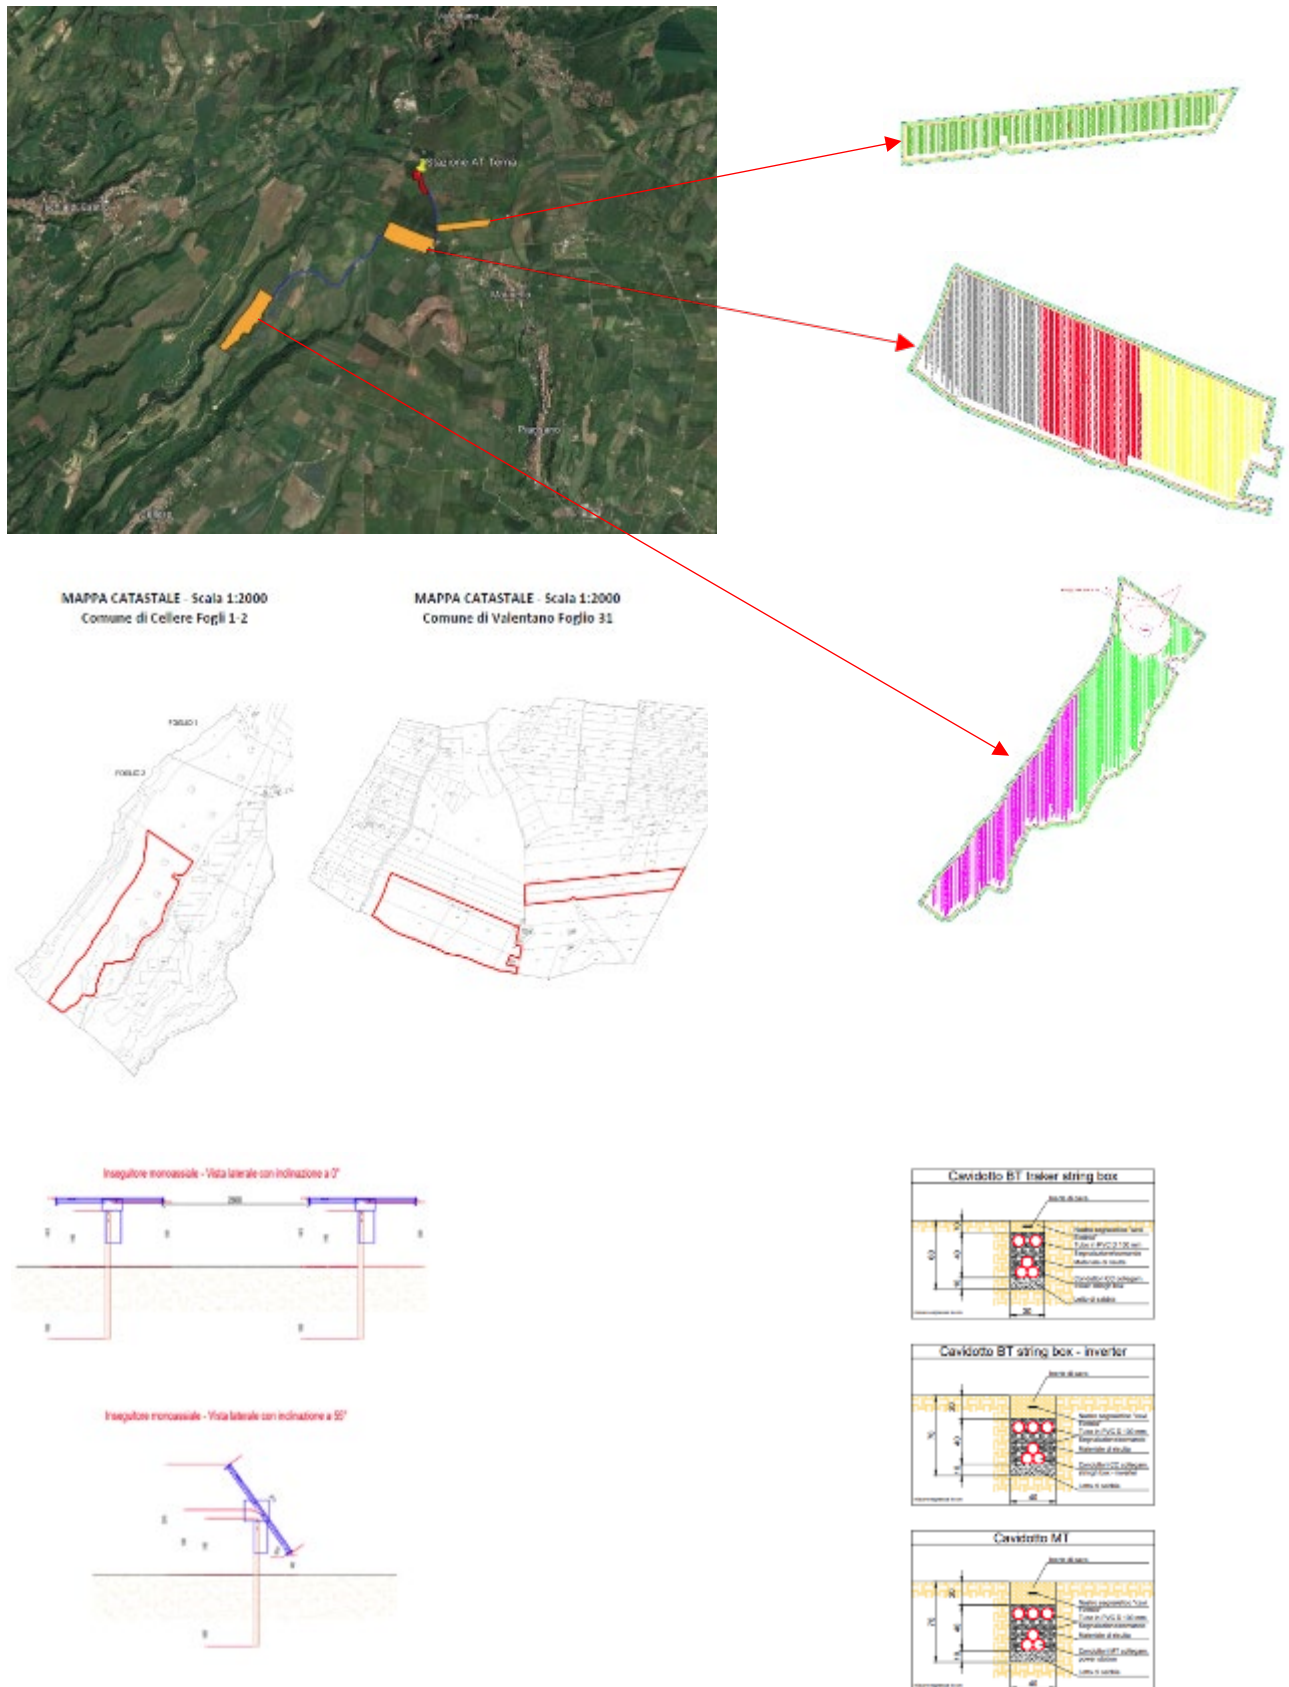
Inquadramento impianto ed opere connessione su ortofoto, catastale, disposizione e particolare tracker; ultima a dx: particolare sezione tipo cavo interrato BT-AT dalla tavola “LAYOUT STRINGHE”
